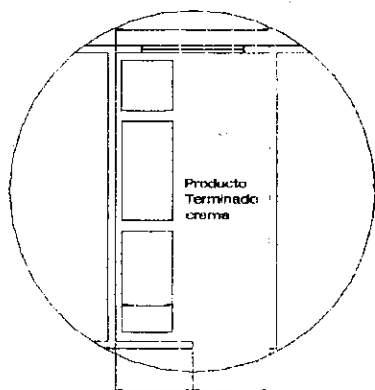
PLANO BODEGA PRODUCTO TERMINADO CREMA
